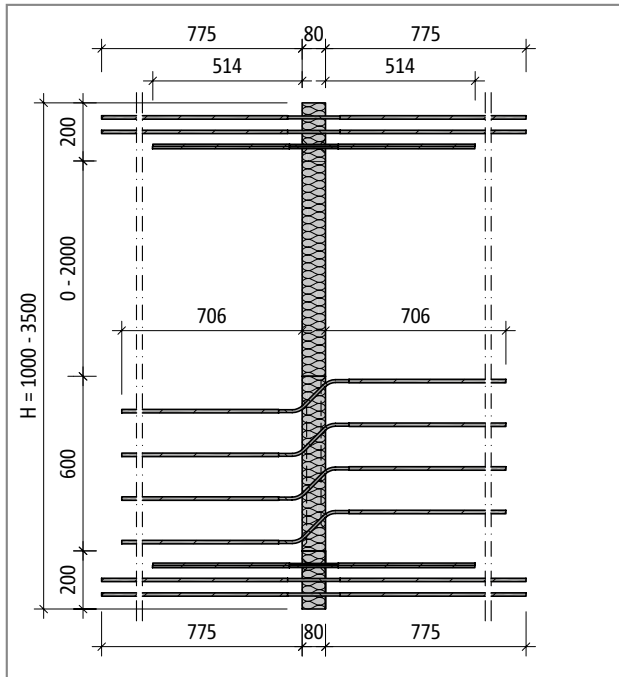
Schöck Isokorb® typ W10S: Půdorys prvku
